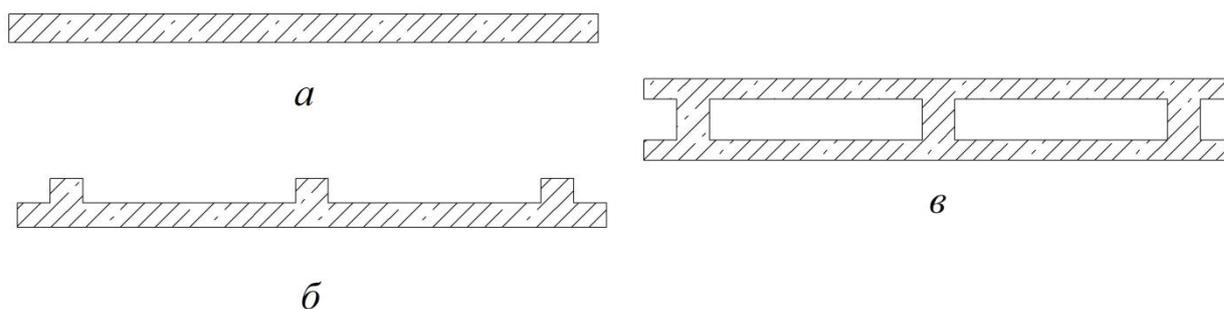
Виды поперечного сечения фундаментной плиты: а – сплошной, б – ребристой, в – коробчатой
